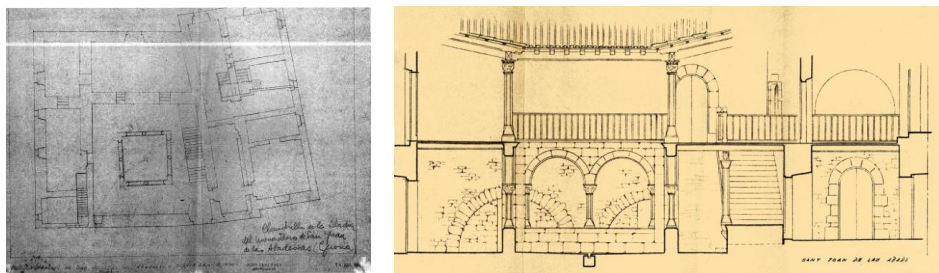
Iglesia de San Juan de las Abadesas AAFV. Planos de proyecto. Planta por Sanz Roca y sección del estudio de Ferrant
